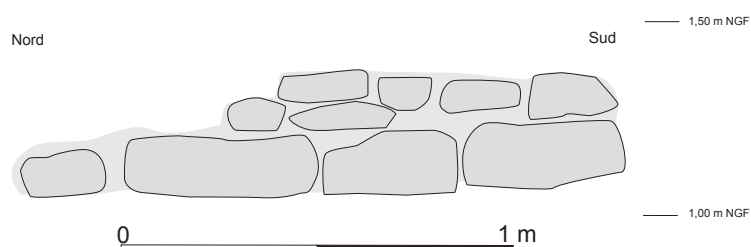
le parement ouest du mur MR 1070 : relevé pierre à pierre (Dessin et DAO A.-G. Chadeffaud/CAV).
